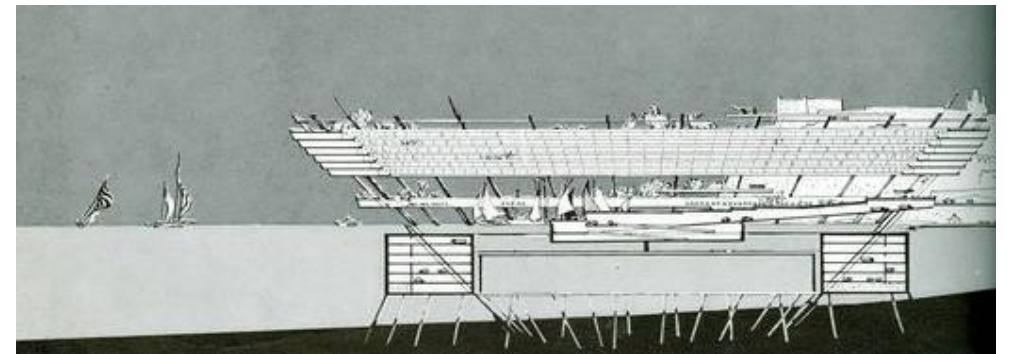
Sección vertical del proyecto Thalassa, 1963, Paul Maymont
